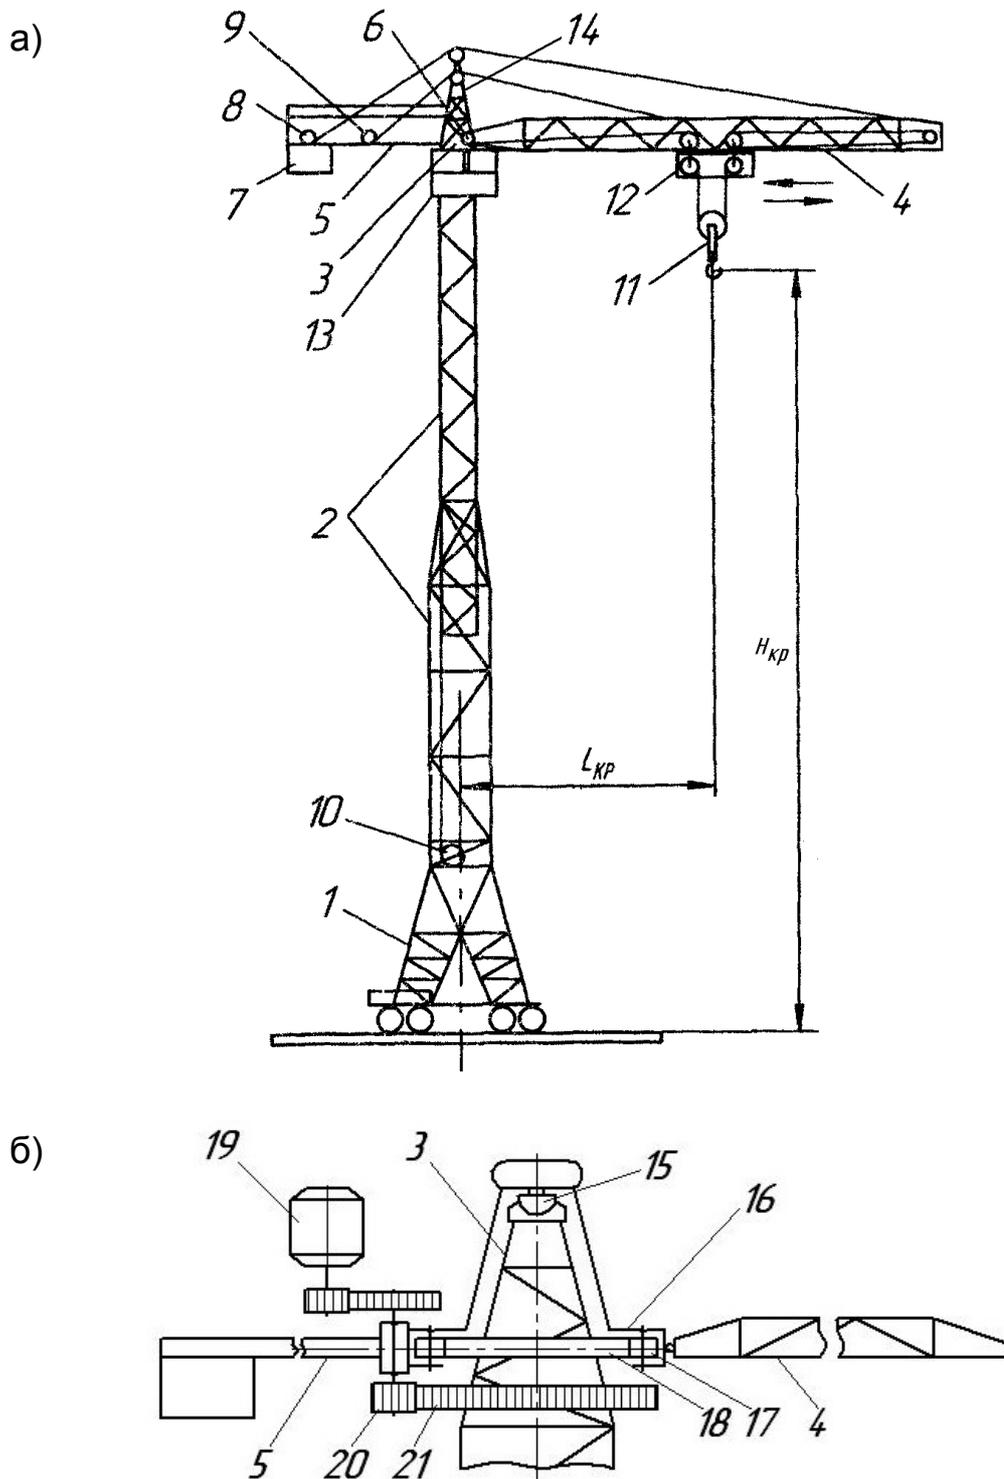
Кран башенный с неповоротной башней М 3-5-10: а - конструктивная схема крана; б – схема опорно-поворотного устройства;
